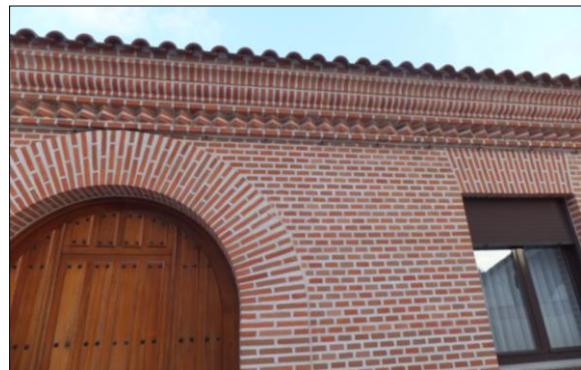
Ejemplo de fachada de ladrillo cerámico cara vista
